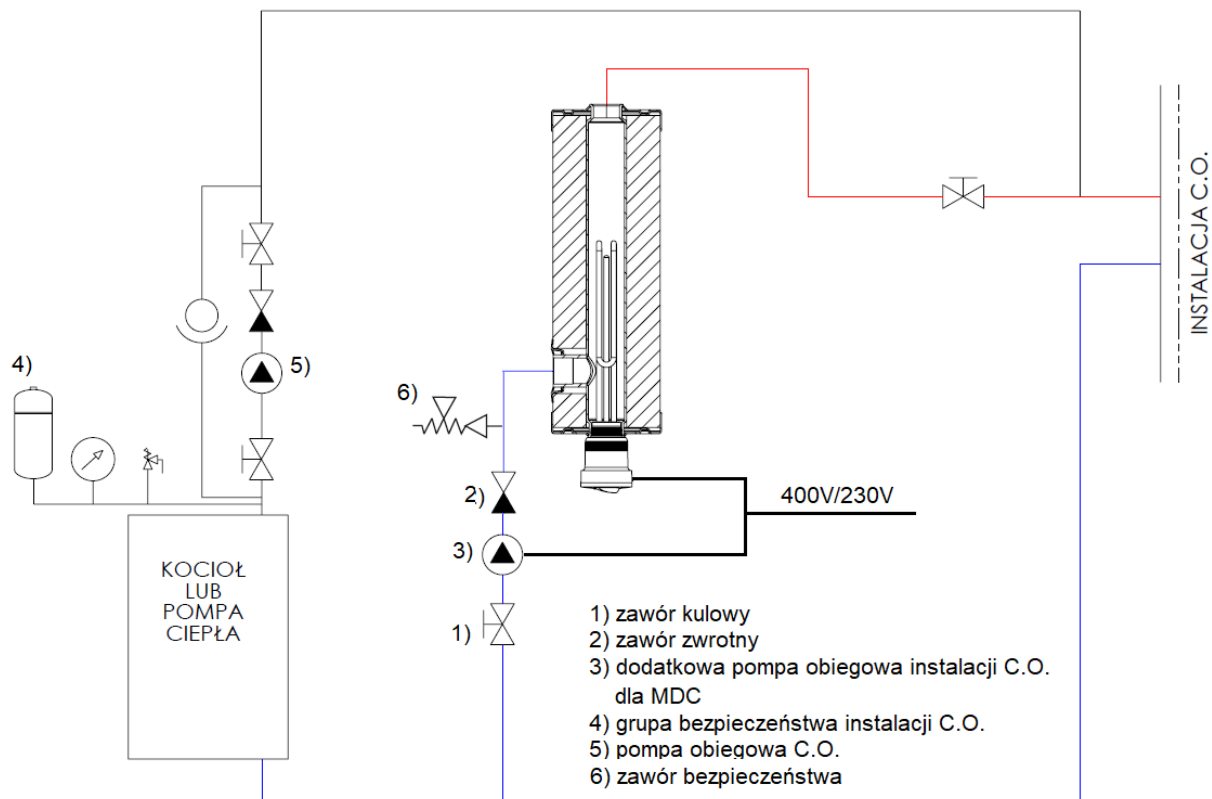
Przykładowy schemat montażu ogrzewacza typu MDC w instalacji C.O. systemu zamkniętego – pozioma pozycja instalacji.
